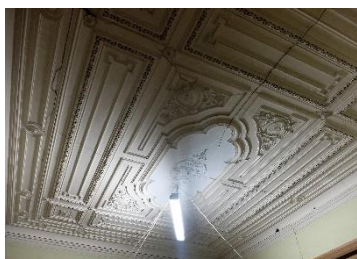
Detalhe do teto, estuque trabalhado pintado de branco
